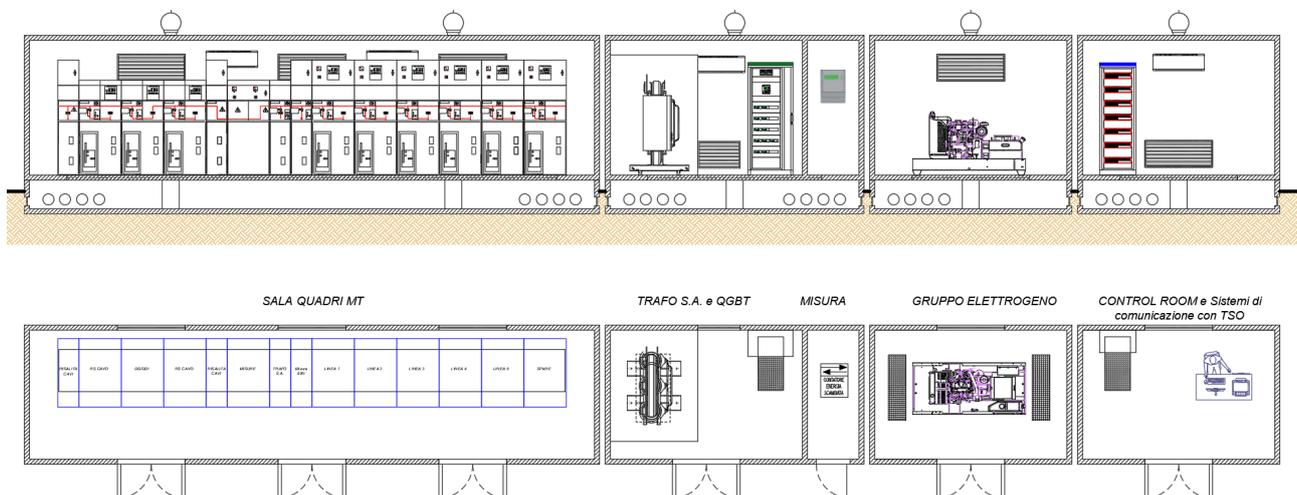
Particolare pianta e sezione cabina di raccolta e smistamento (Rif. FV.MNR03.PD.H.02)
